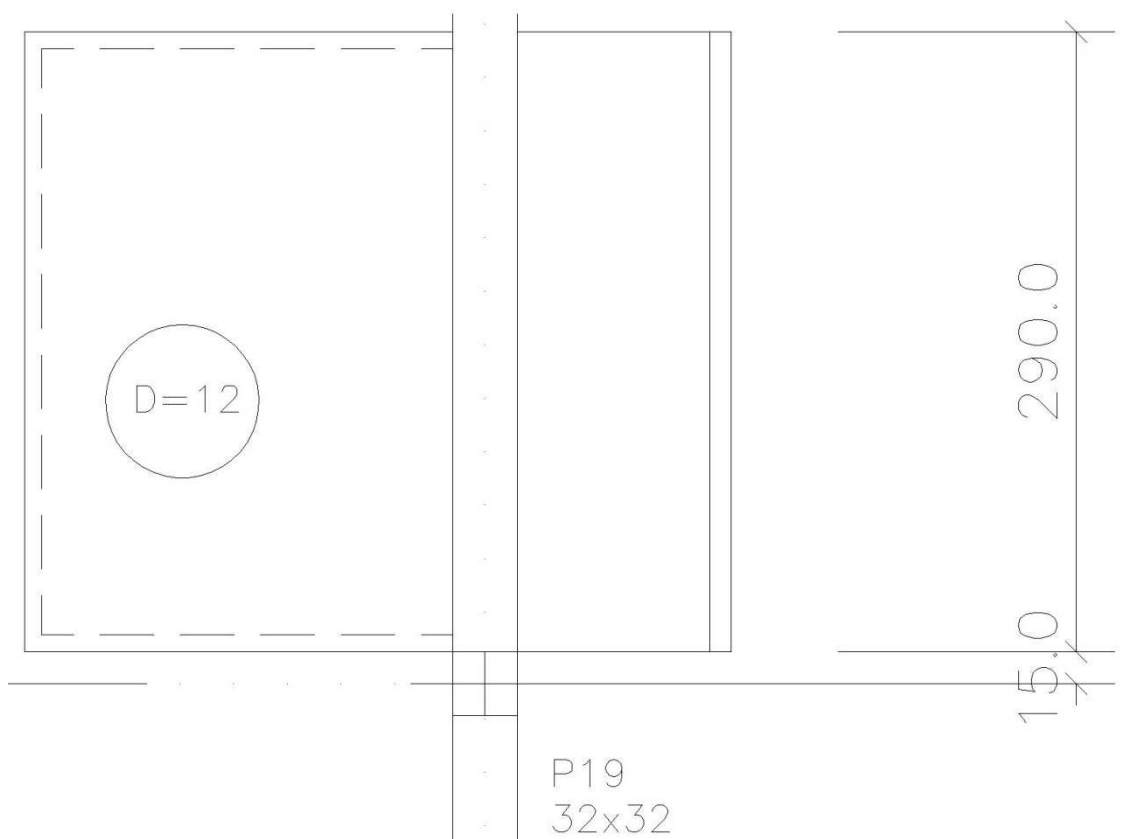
Planta de forma do 1º pavimento do projeto estrutural, marquise localizada a sul da edificação.
